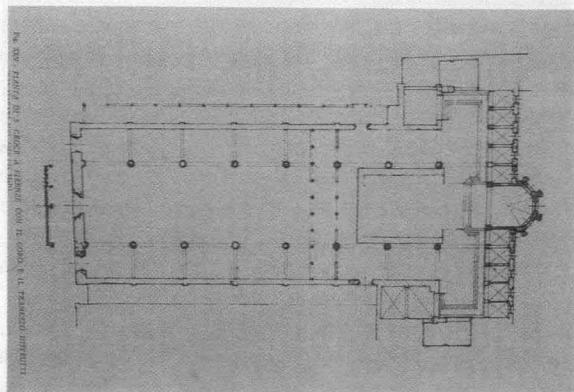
Planta de Santa Croce de Florencia con el tramezzo divisorio de la nave.
